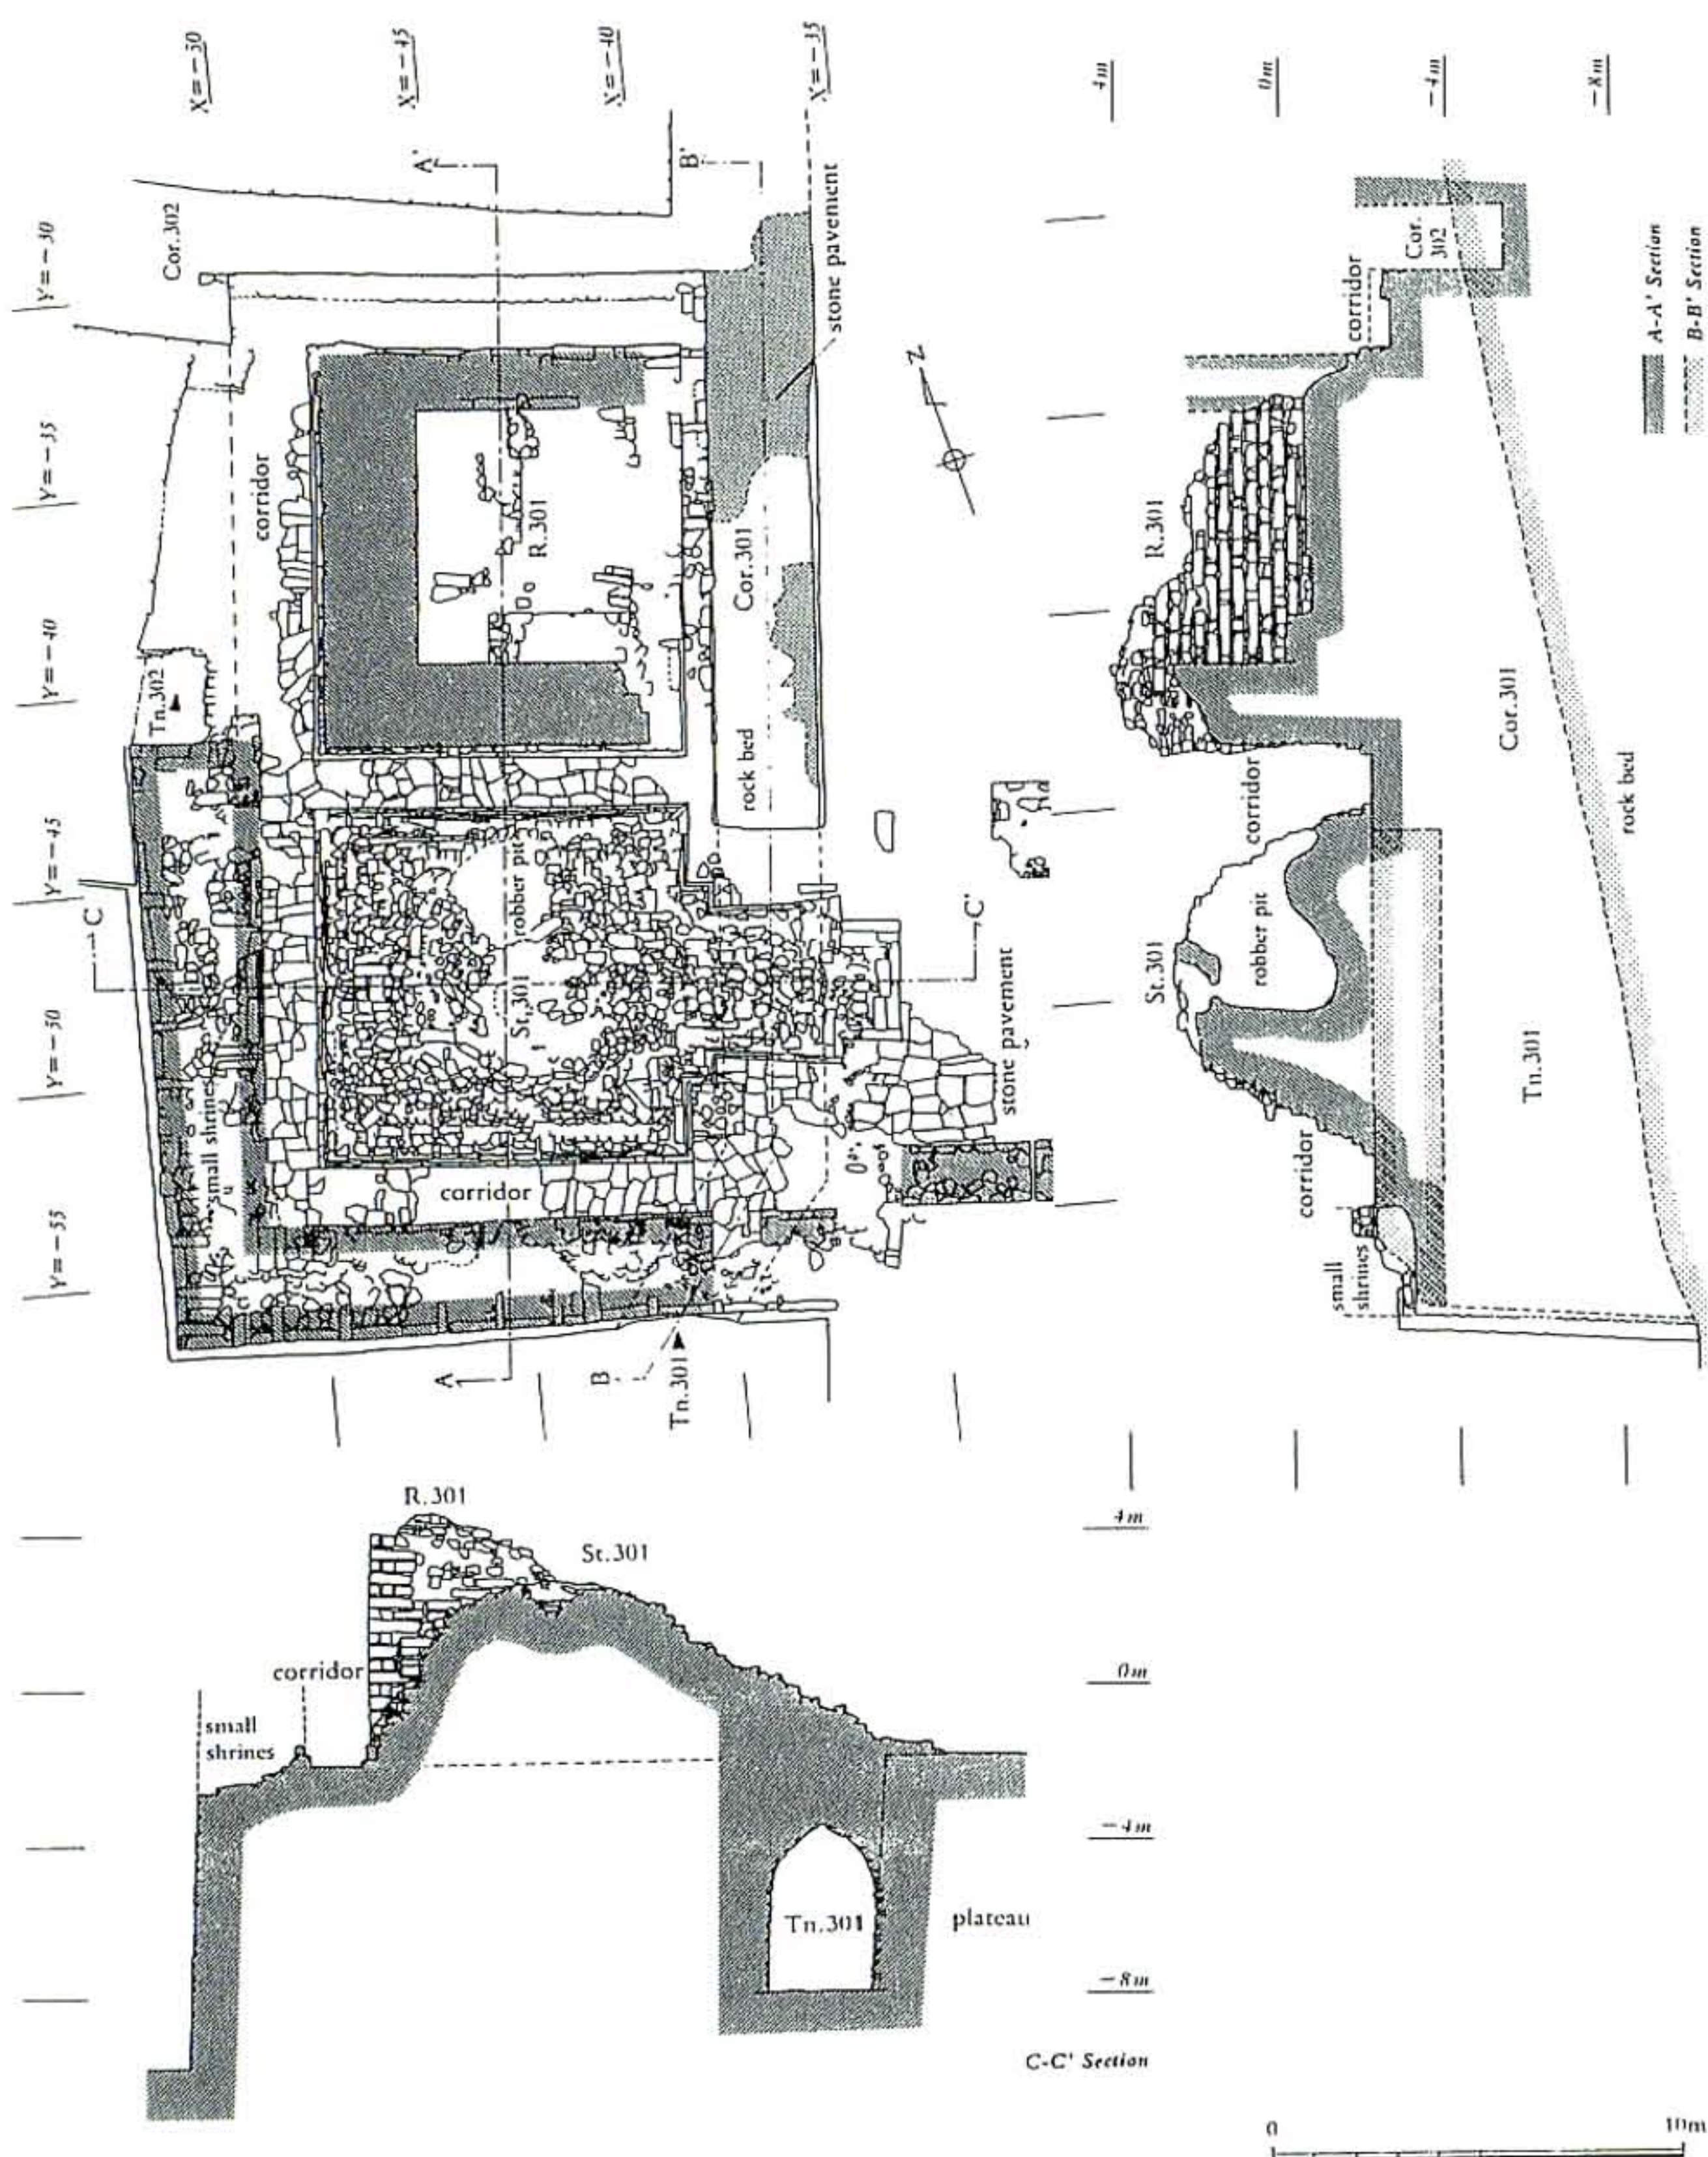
西南塔と西南祠堂 平面図・断面図 South-west Stupa St. 301 and South-west Shrine R. 301, Plan and Sections
